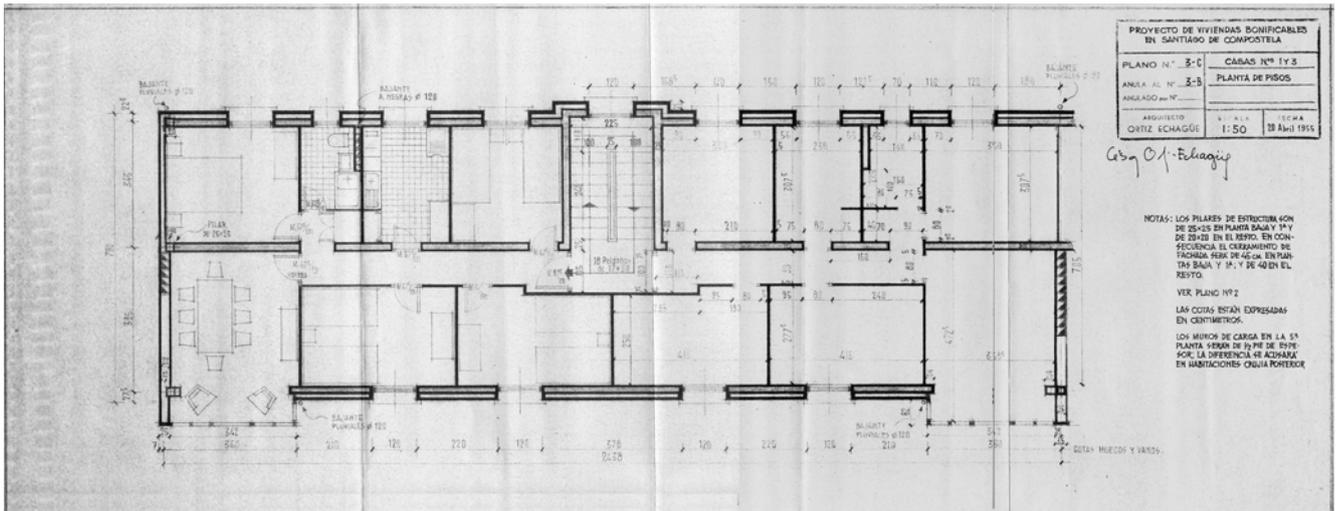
Plano N° 3-C, abril 1955. Planta de pisos de las casas N° 1 y 3.
